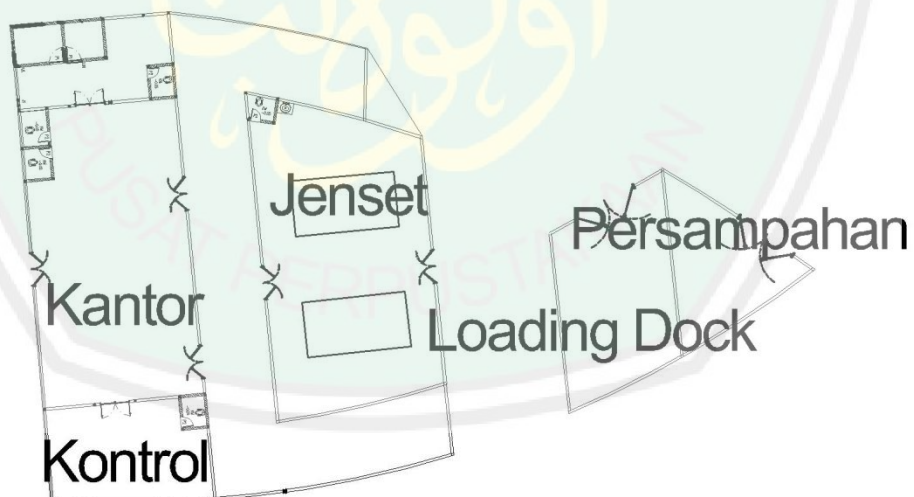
Denah lantai 1 Tribun *Outdoor
